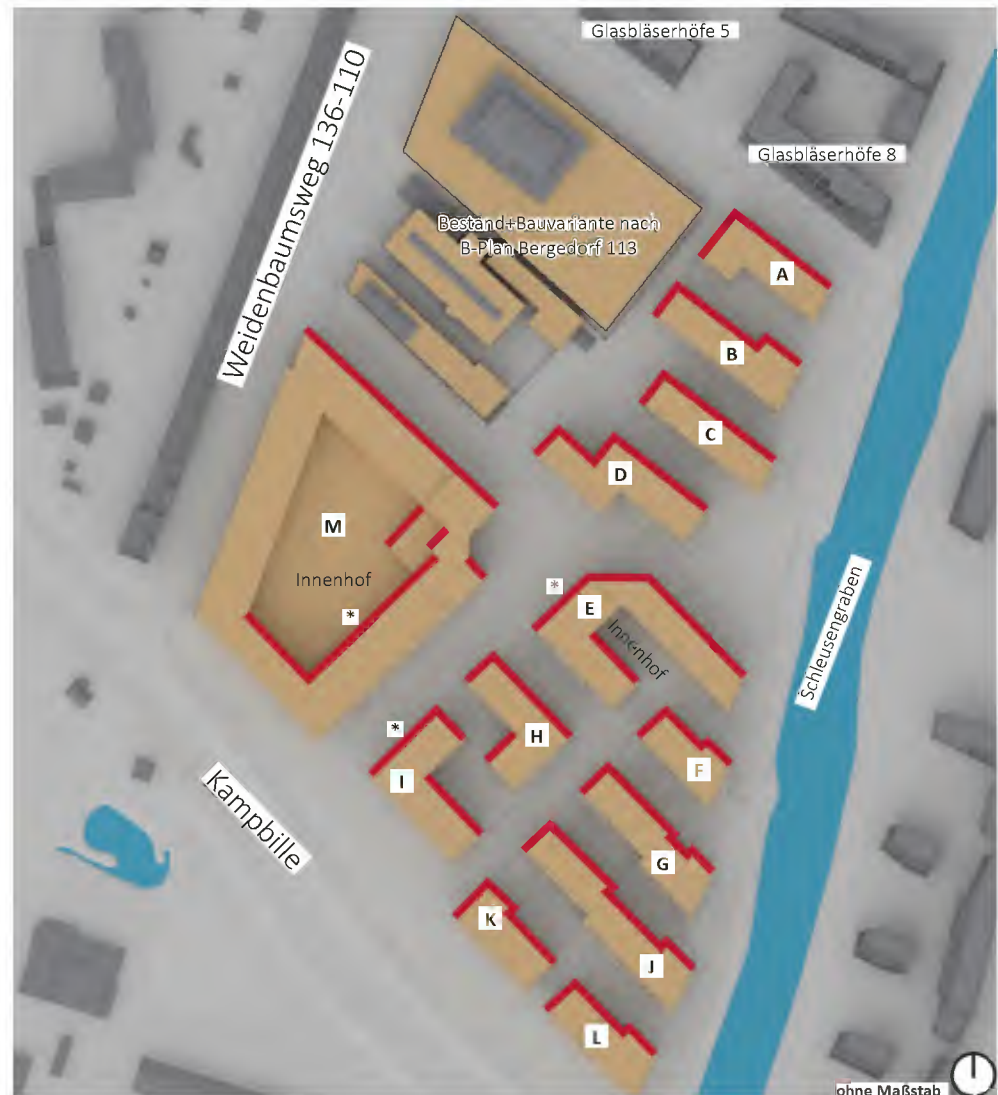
Verortung der Fassadenabschnitte mit unter 90 Minuten Besonnung Fensterlaibungsinneseite aufgrund der Himmelsausrichtung
